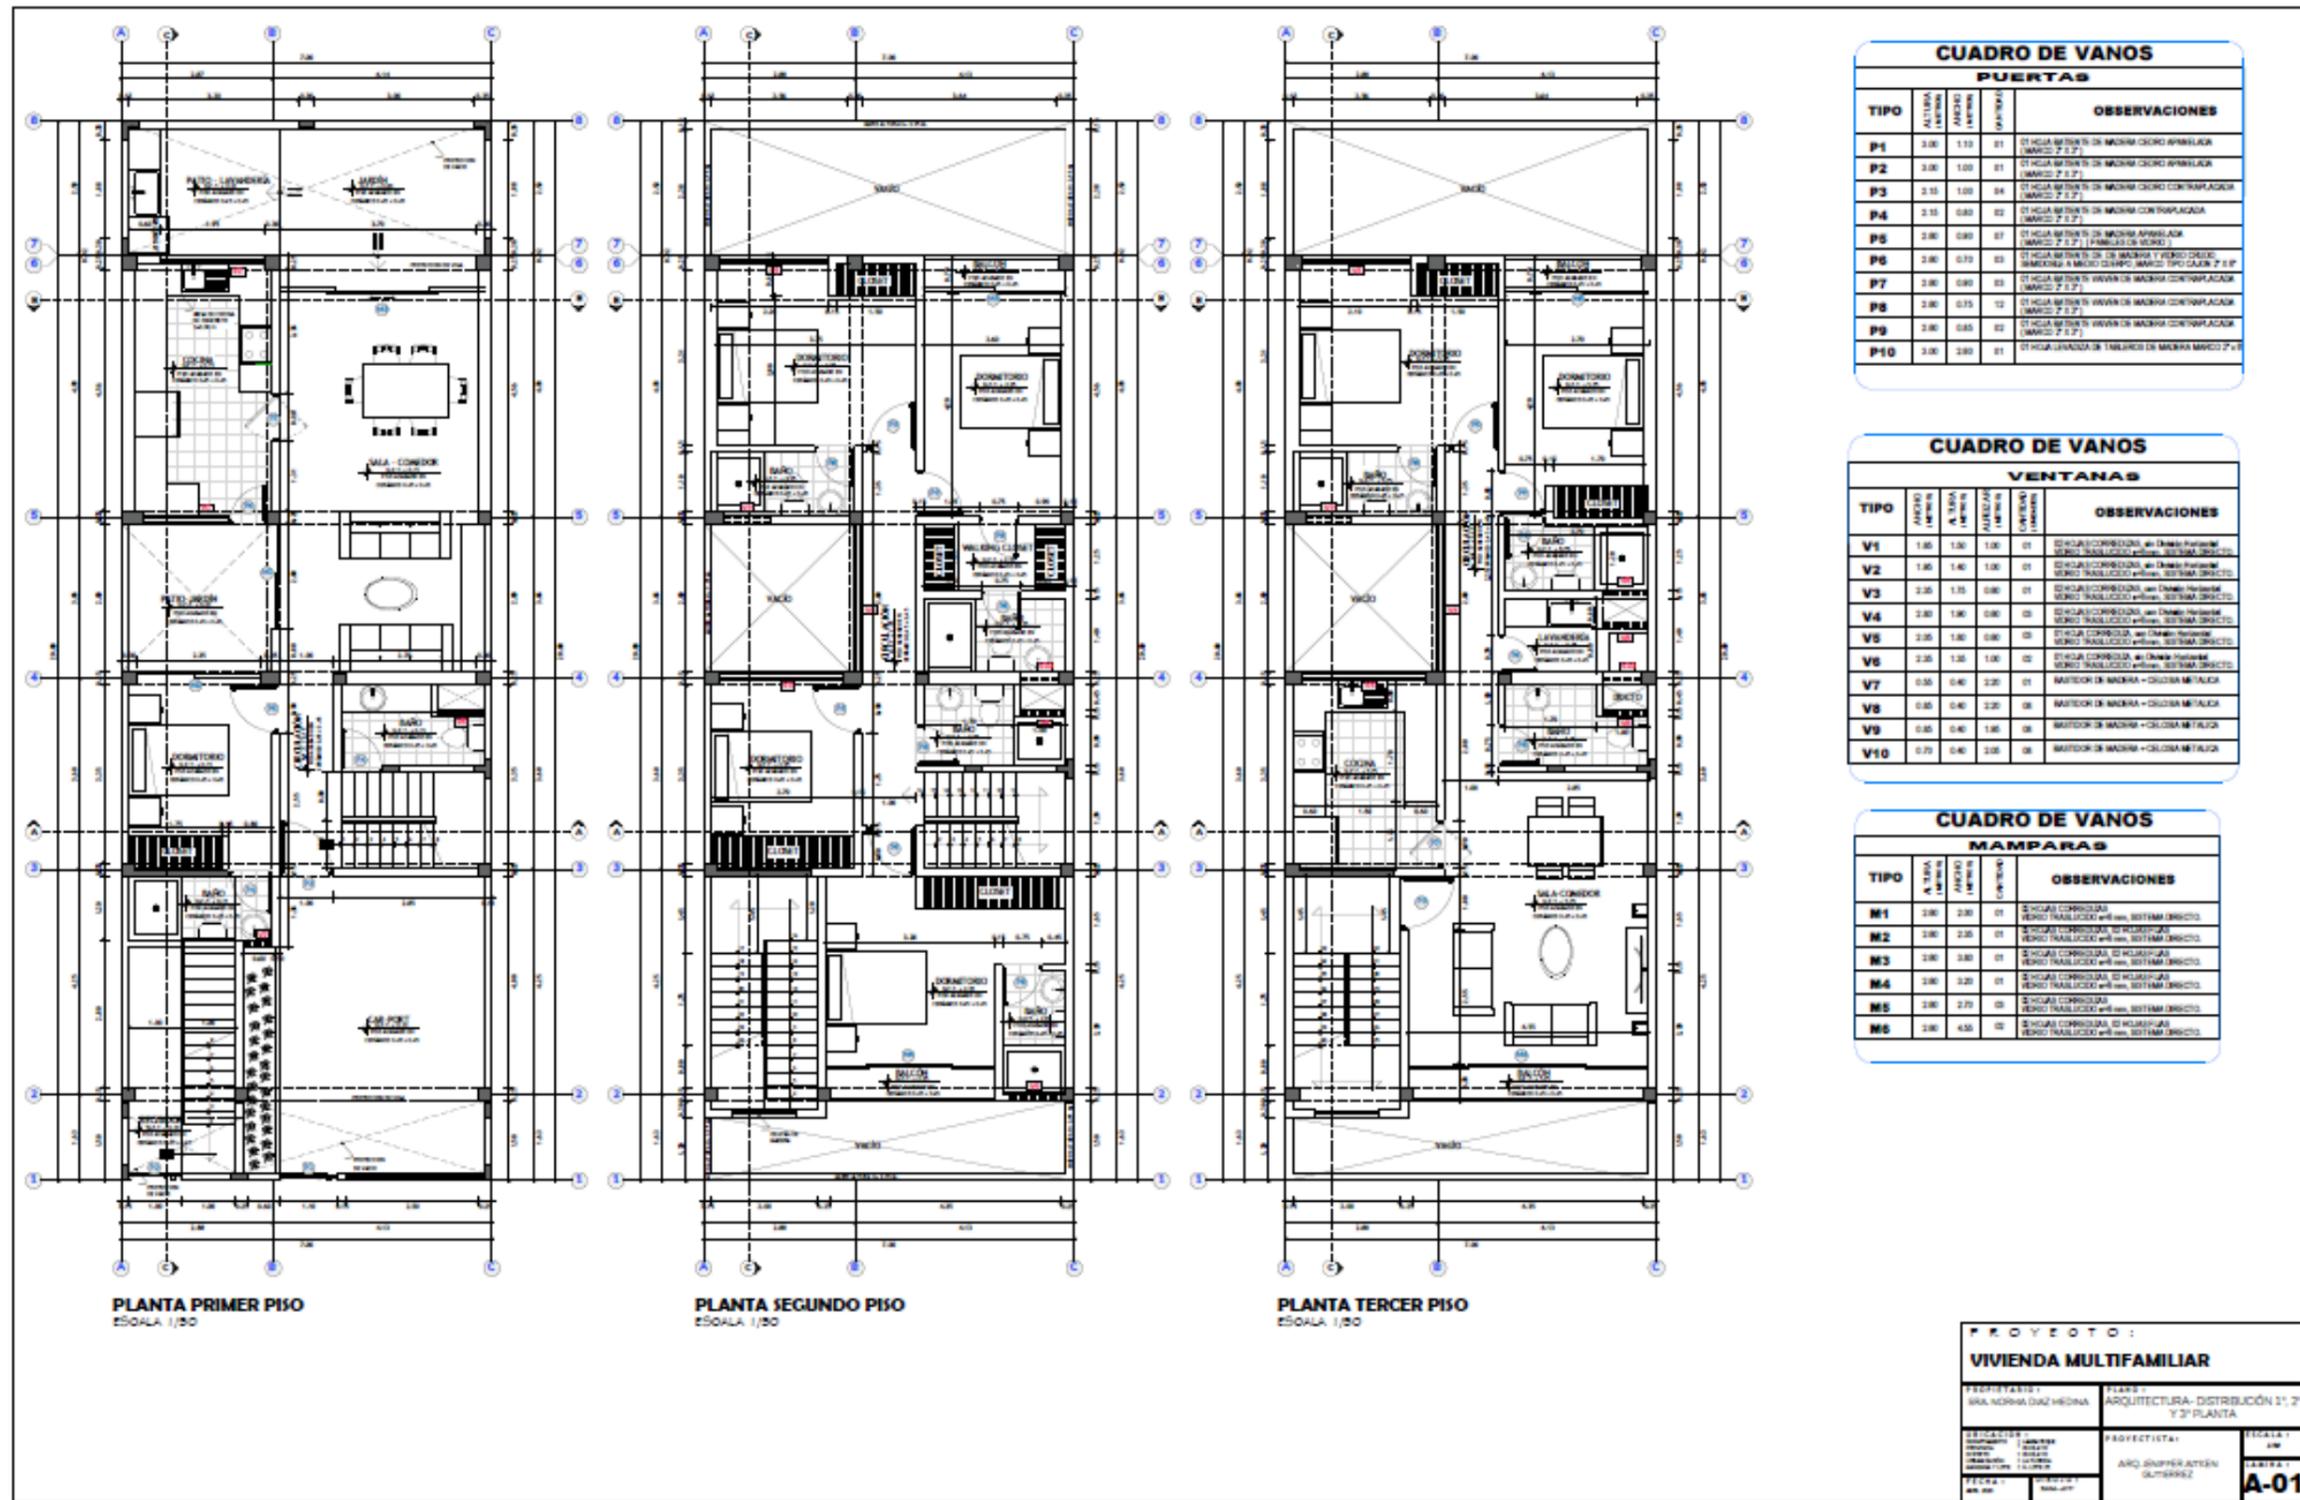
Planos de Distribución arquitectónica de los tres primeros niveles del proyecto
